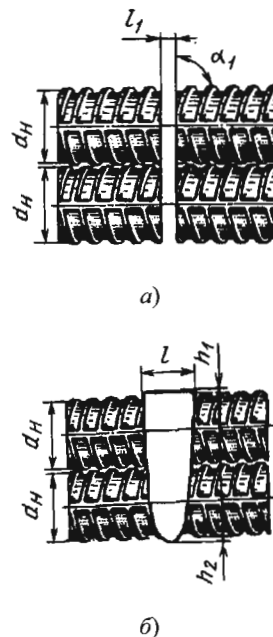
Вид подготовки кромок (а) и сварного соединения (б) ВМ-2
